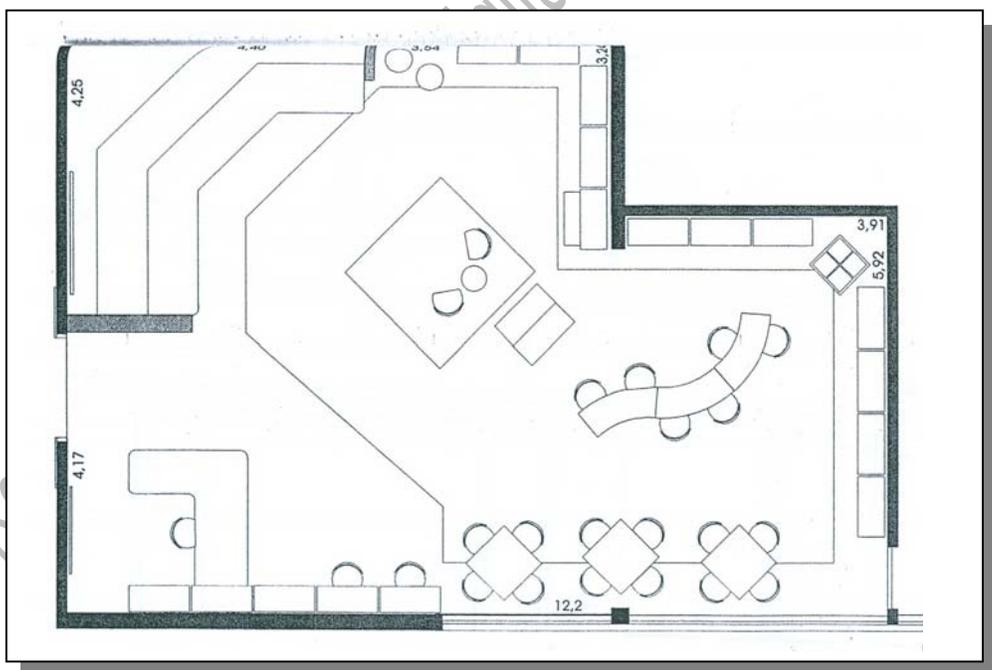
Planta baixa do lay-out final da Biblioteca Escolar Interativa EMPG Professor Roberto Mange
